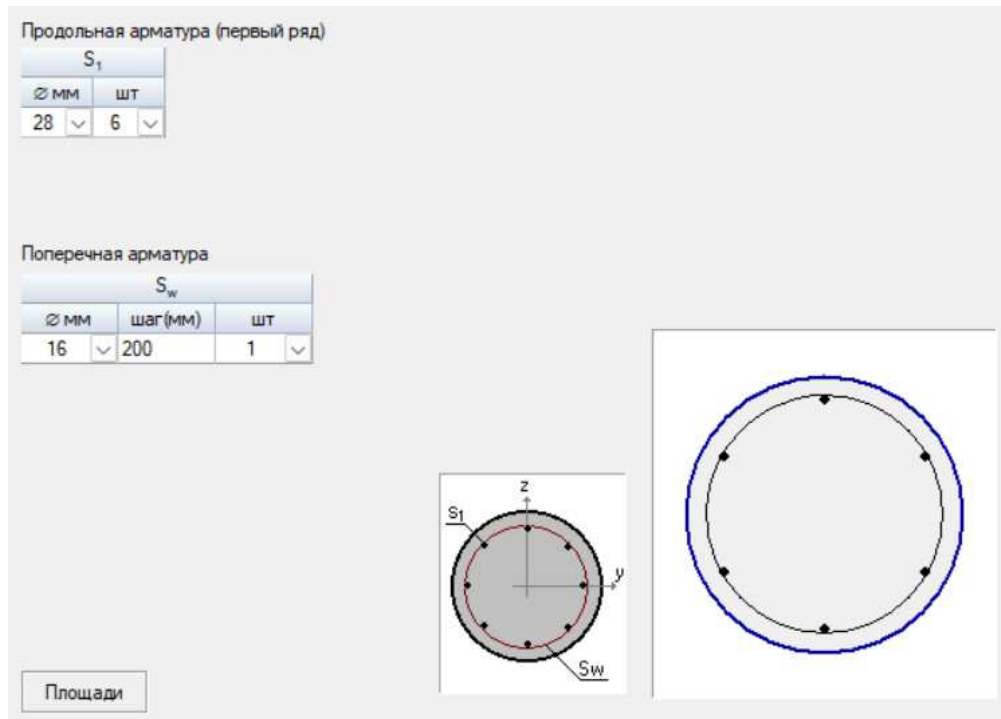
Армирование колонн с 35-40 (d700)
